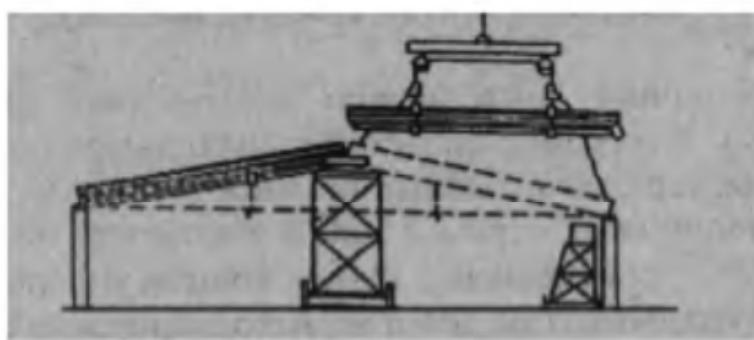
Монтаж металлодеревянных арок с применением монтажной башни
